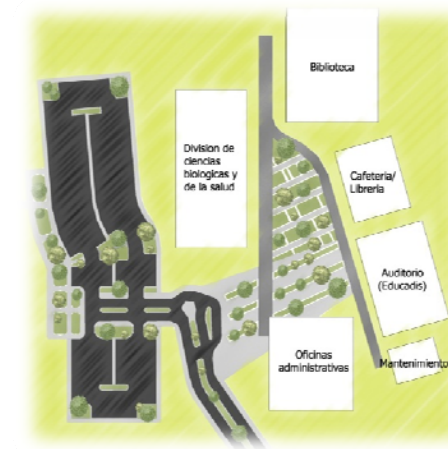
Primera propuesta de zonificación detallada del área académica
